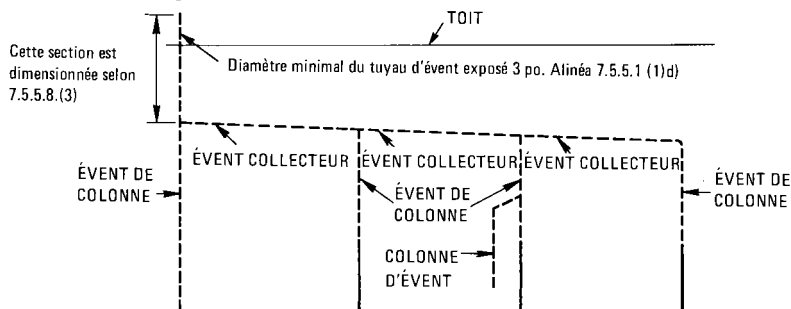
Dimensionnement de la section libre d'un événement de colonne et d'une colonne d'évent
